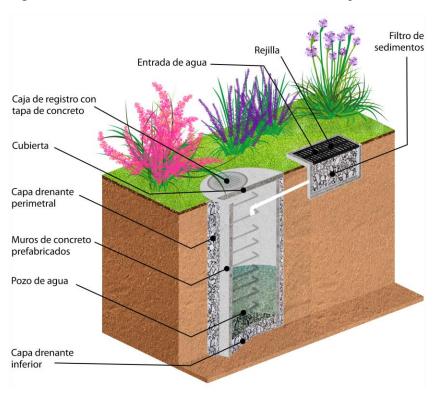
Pozo de infiltración con muro de concreto prefabricado
